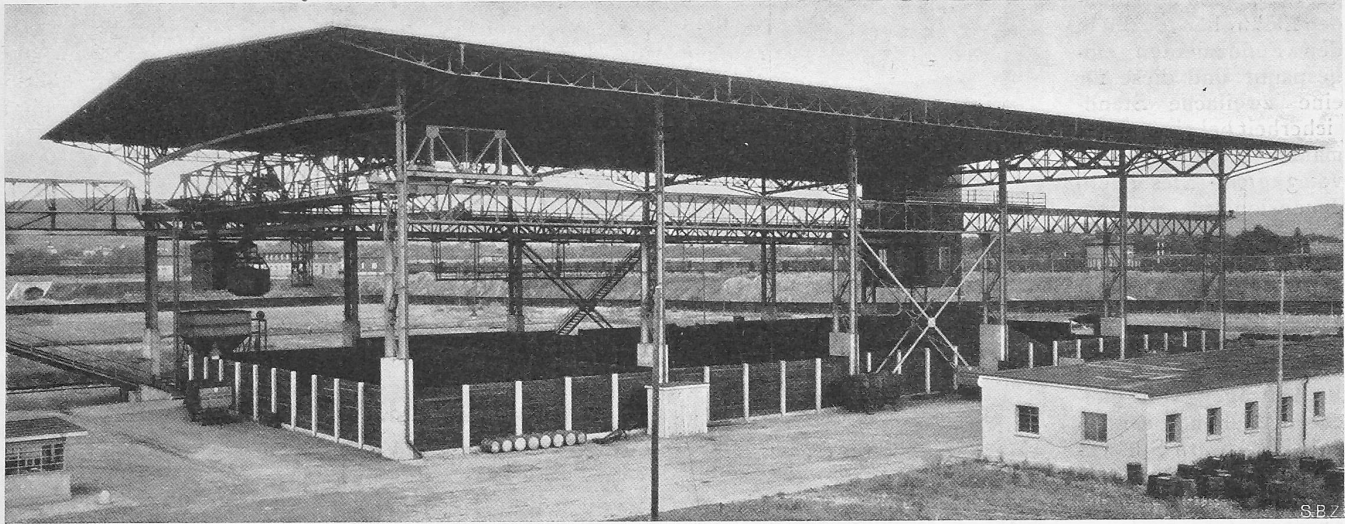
Gesamtbild der Kokshalle im neuen Gaswerk Kleinhüningen der Stadt Basel. Links Hängebahn-Brücke zur Ofenanlage.
